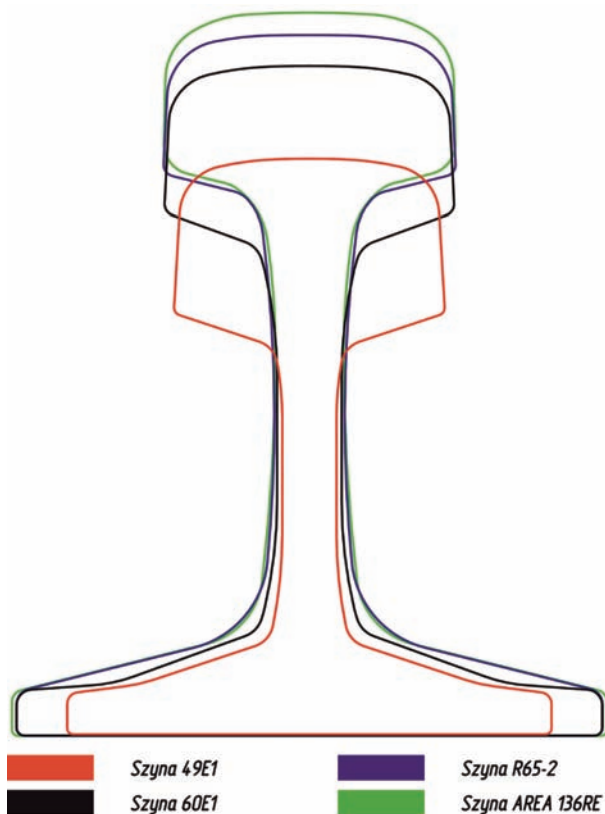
Przekrój poprzeczny szyny R65-2 [18]
